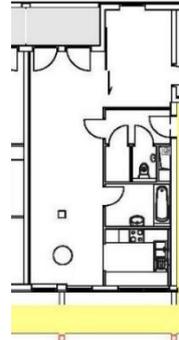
Wohnung mit zentralem Wohn/Essbereich und angeschlossener Küche, Bauteil Arch. Podreka
